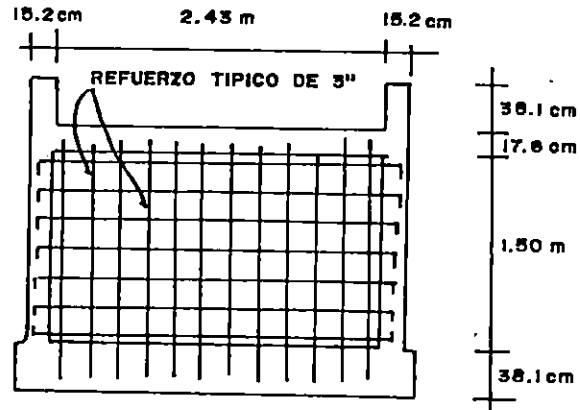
a - MURO COLADO MONOLITICAMENTE
